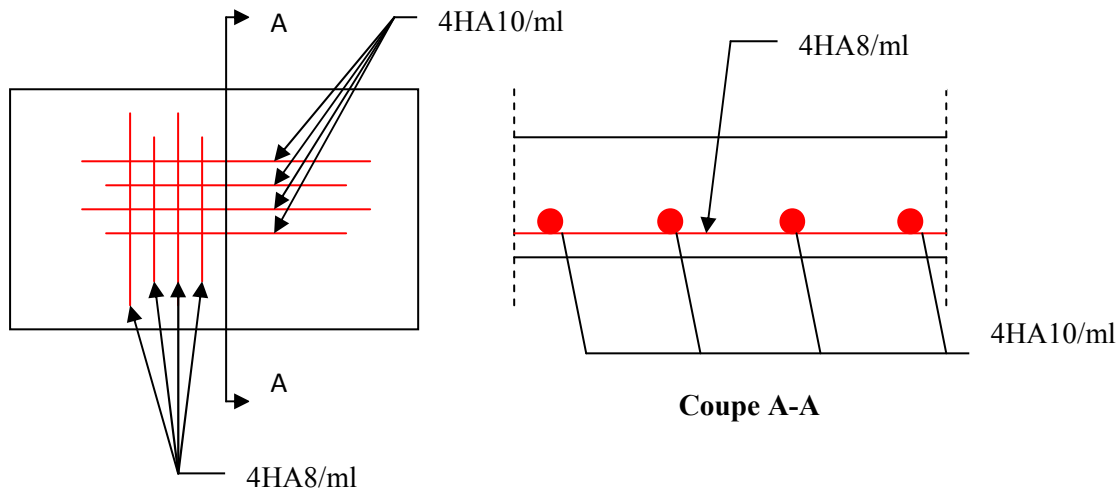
Schéma de ferrailage de la dalle sur trois appuis.
